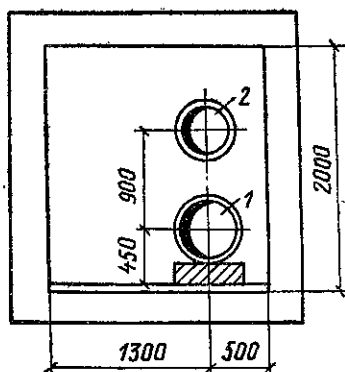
Схема укладки в туннеле водопроводных труб большого диаметра
